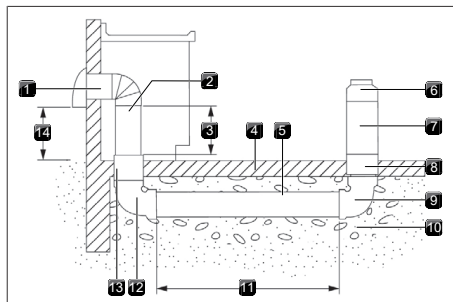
Instalaciones de losas de hormigón – Escape a través del muro
